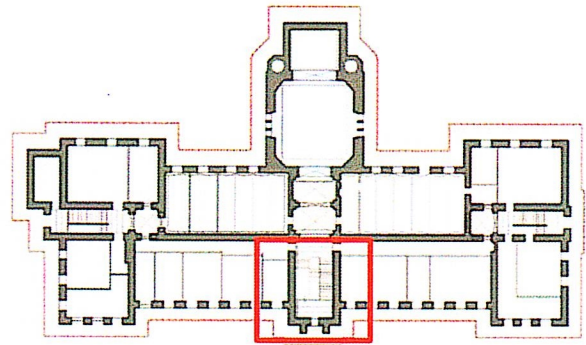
План первого этажа с обозначением помещения (местоположение парадной лестницы)
